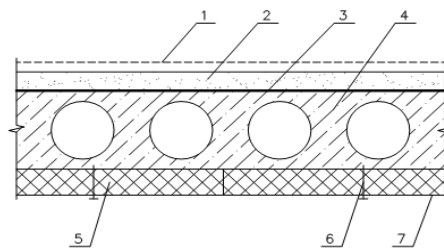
Структурне рішення для утеплення перекриття з багатопустотних плит, спрямованого на неопалювальне підвальне приміщення: 1 – покриття підлоги; 2 – цементно-піщана або бетонна стяжка; 3 – шар пароізоляції; 4 – перекриття із багатопустотних плит; 5 – матеріал утеплення; 6 – дюбель для кріплення ізоляційного матеріалу; 7 – повітрязахисна мембрана
